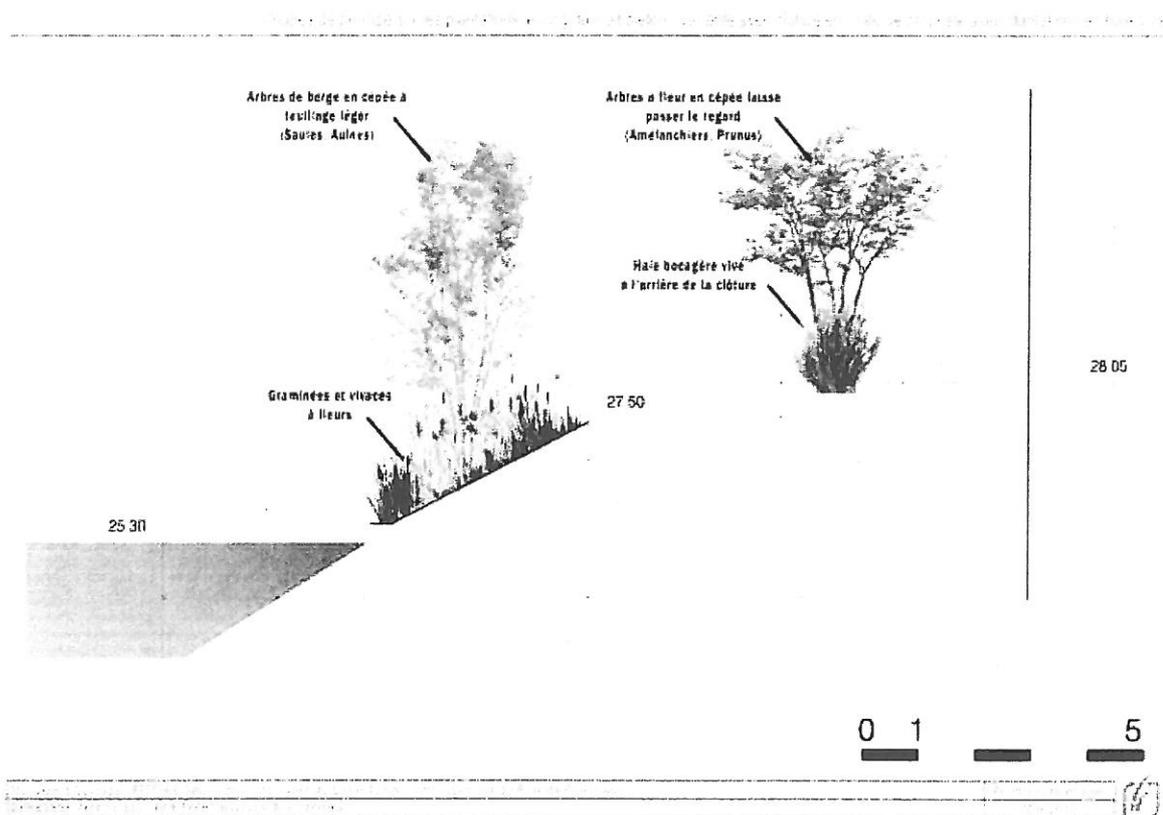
Coupes de principe sur les plantations le long du mail piéton (TRAIT VERT, Mai 2012)
